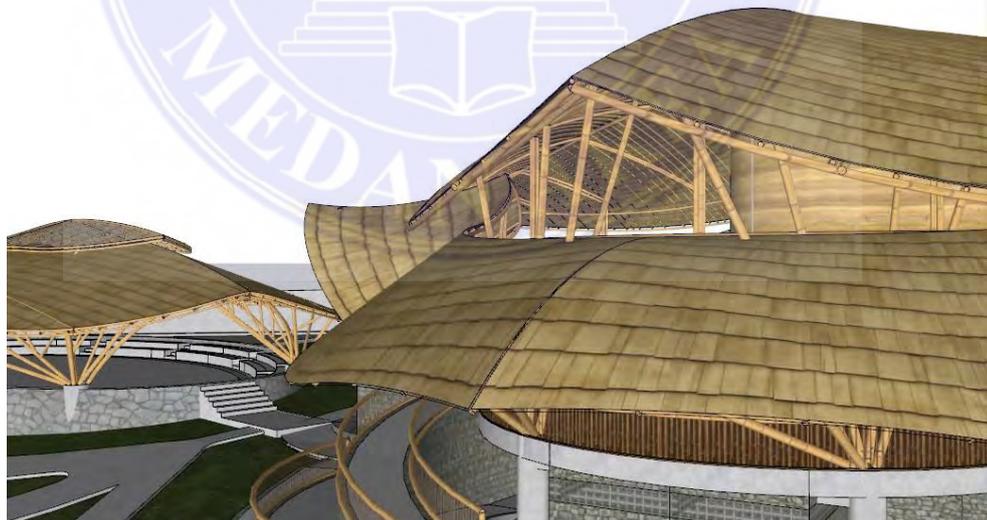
22 Penerapan Kolom Bambu Pada Desain
